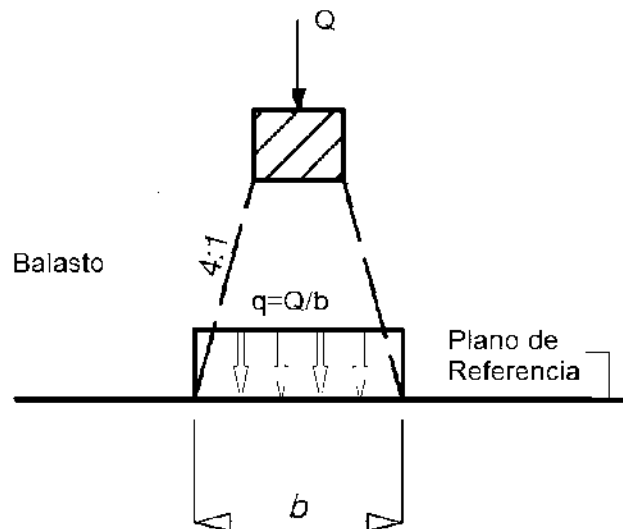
Distribución longitudinal de la carga a través de un durmiente y del balasto.
